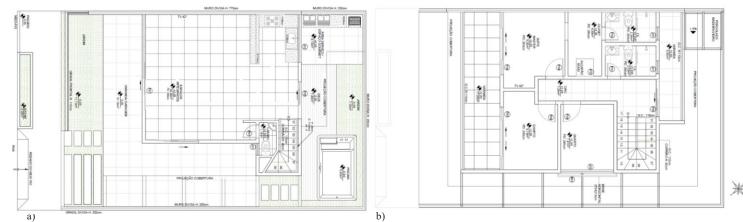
a) Layout do 1°. b) Layout do 2° pavimento. Fonte: Gtop, 2019 [16].
